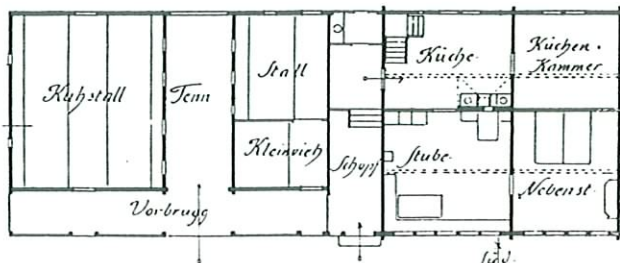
Grundriss eines grösseren Hauses mit Scheunenbau
